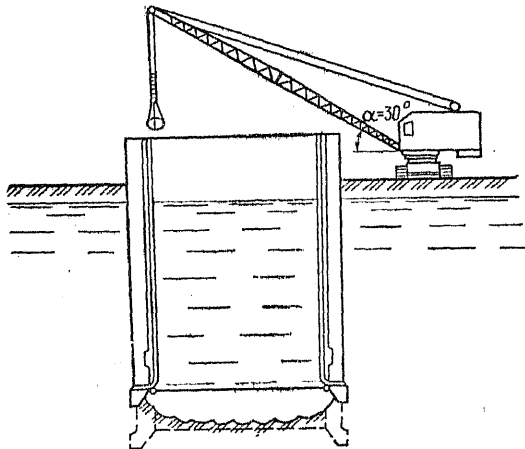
Схема опускания колодца с выемкой грунта из-под воды
